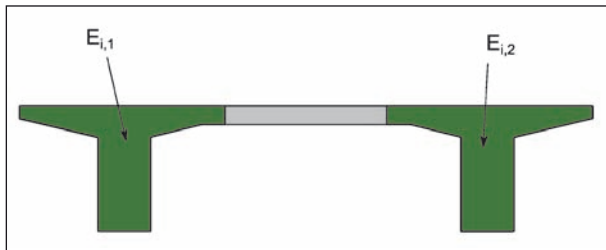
Doppelstegiger Plattenbalken, der als Parallelsystem zweier Balken (Elemente) modelliert wird
